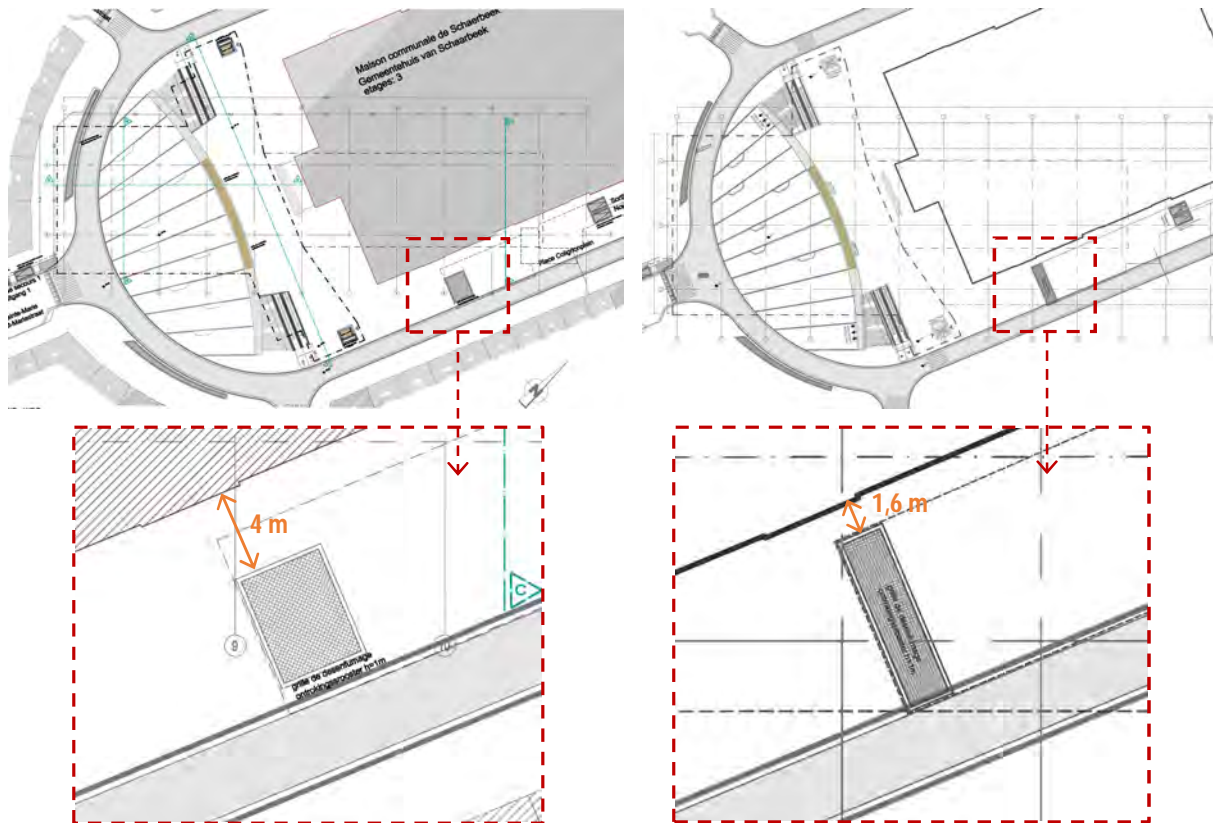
Plan d'implantation du rez-de-chaussée de la station Colignon ; détail de la grille de désenfumage : monotube (à gauche) et bitube (à droite) (BMN, 2017 & 2020)
